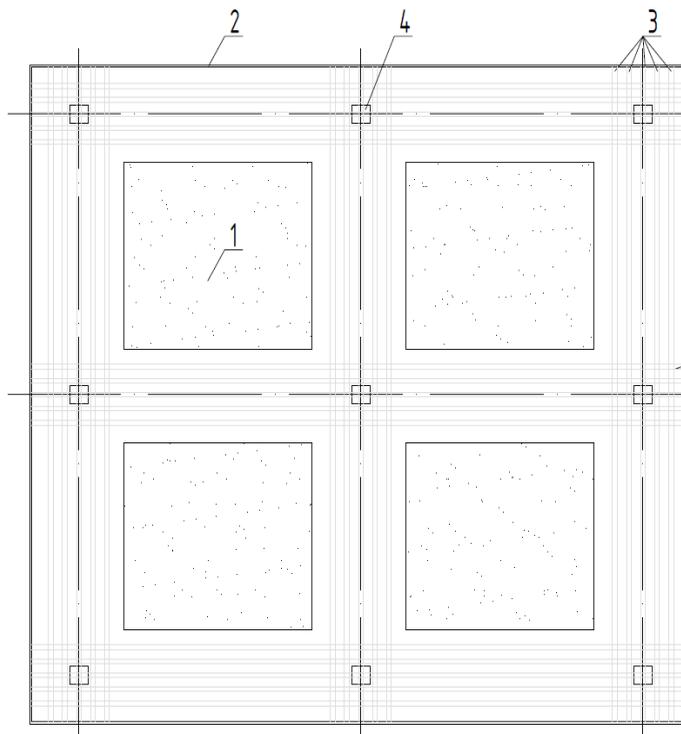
Схема устройства плитного фундамента рамной конструкции с предварительным напряжением арматуры в построечных условиях (1 – ячейки-полости, 2 – опалубка внешняя, 3 – каналообразователи с напрягаемой арматурой, 4 – места расположения колонн)
